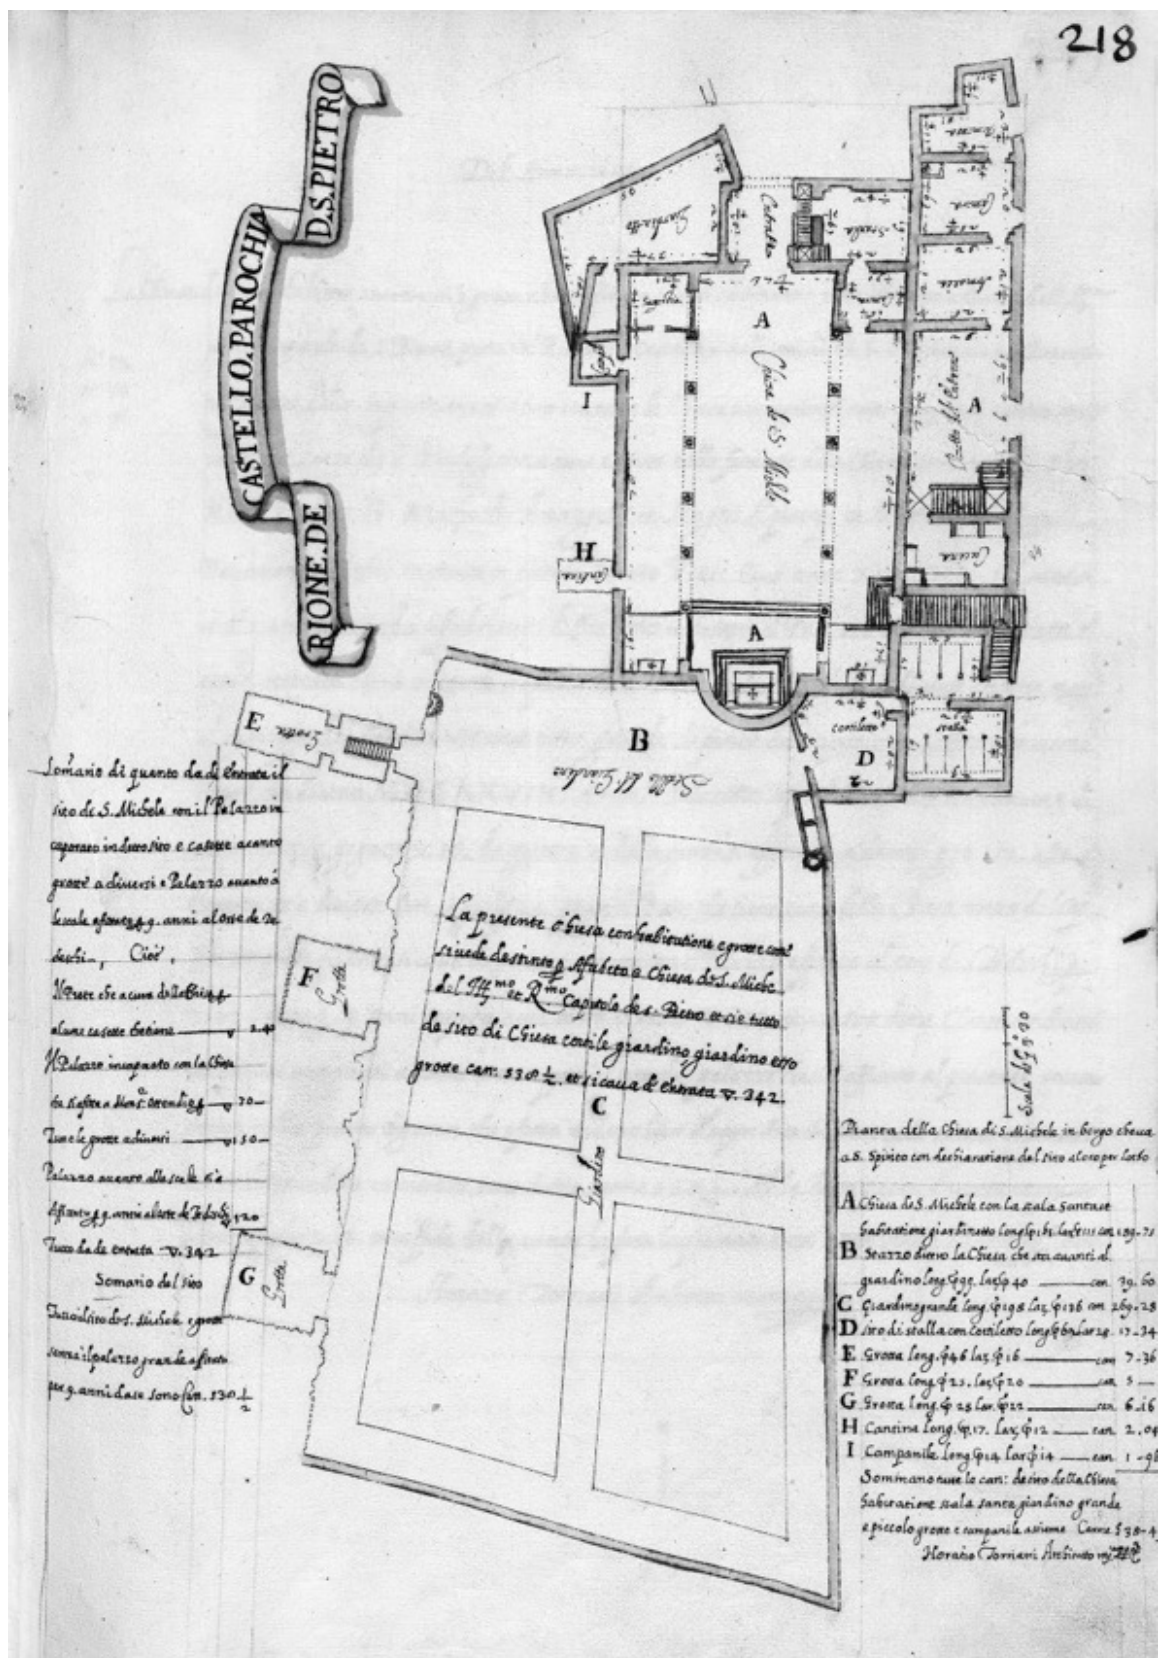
Rom, SS. Michele e Magno, Prospero de Rocchi, Grundriss mit umgebenden Gebäuden und Gärten, 1600.
